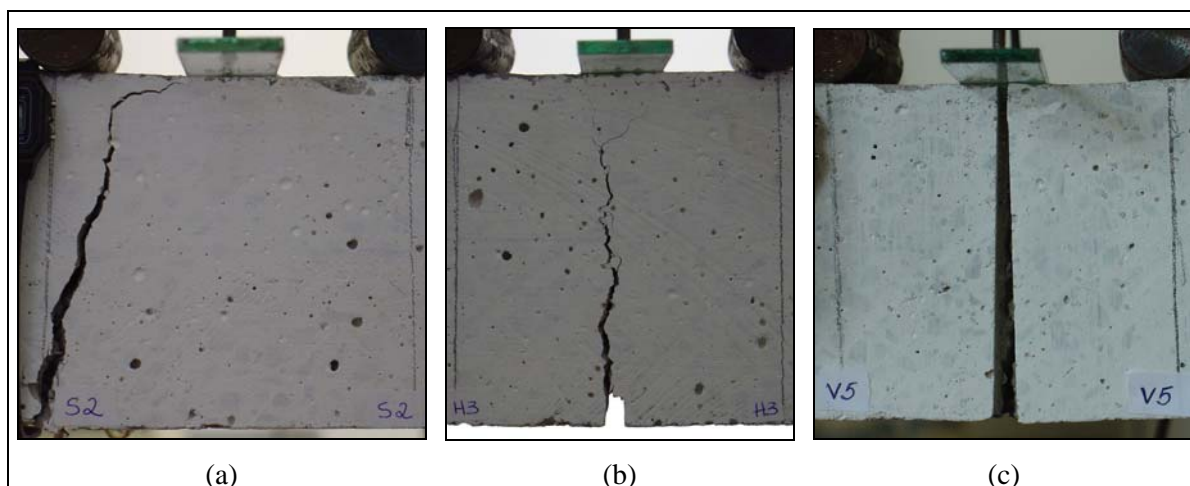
Configurações típicas de aberturas de fissuras para: (a) vigas sem entalhe (S); (b) vigas com entalhe na parte inferior (H) e (c) vigas com entalhes nas laterais (V).
